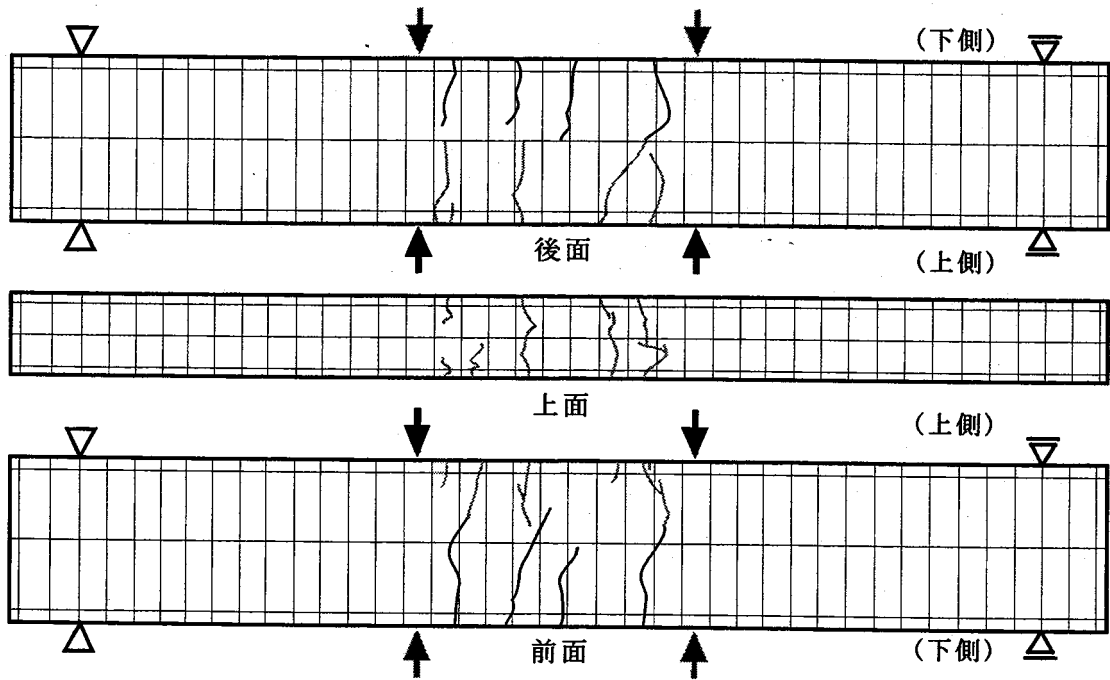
a) ひび割れ性状 [BS-2 ; R = 1/1600rad.]
